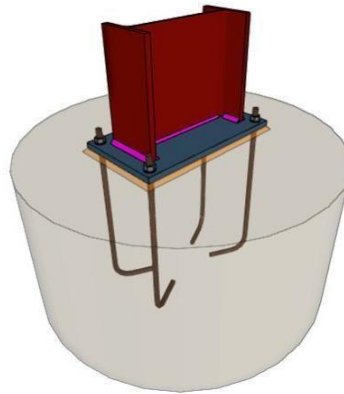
Placa de anclaje para pilares del forjado y pilares traseros
